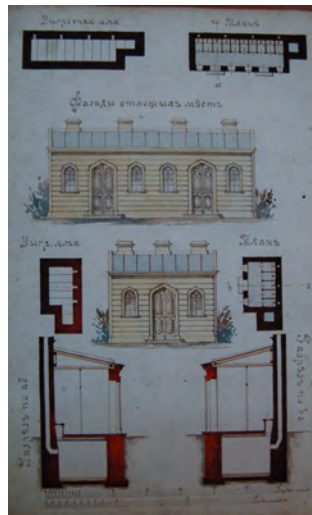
Planmaterial; Grundrisse; Ansichten; Schnitte
